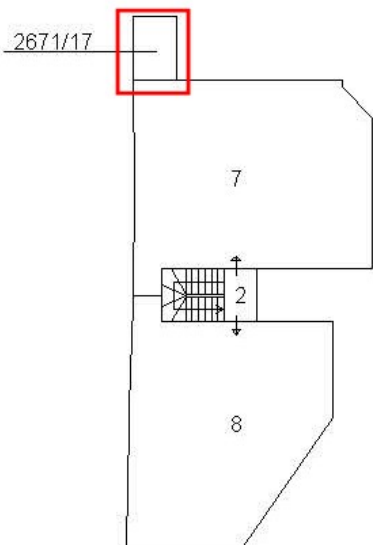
Elaborato planimetrico particella 2681 Figura 6 – Elaborato planimetrico particella 2681
